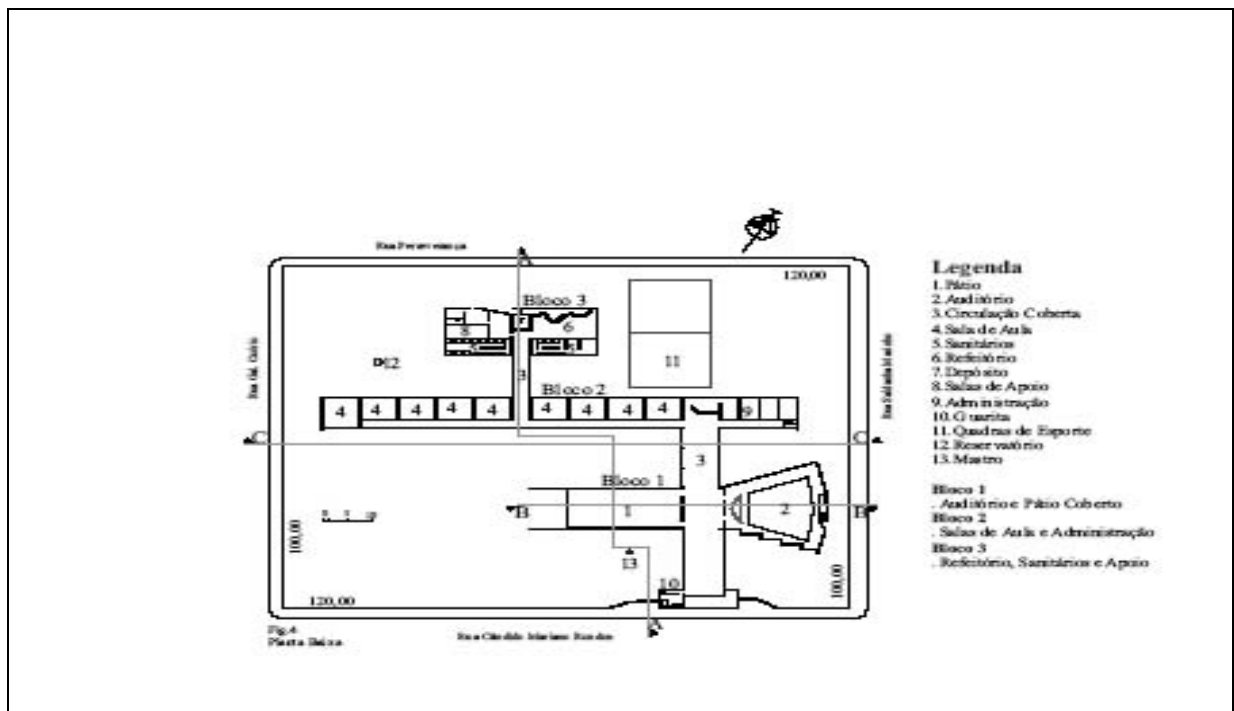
Planta baixa do Maria Constança – Fonte: Arruda (2001, p. 135)
